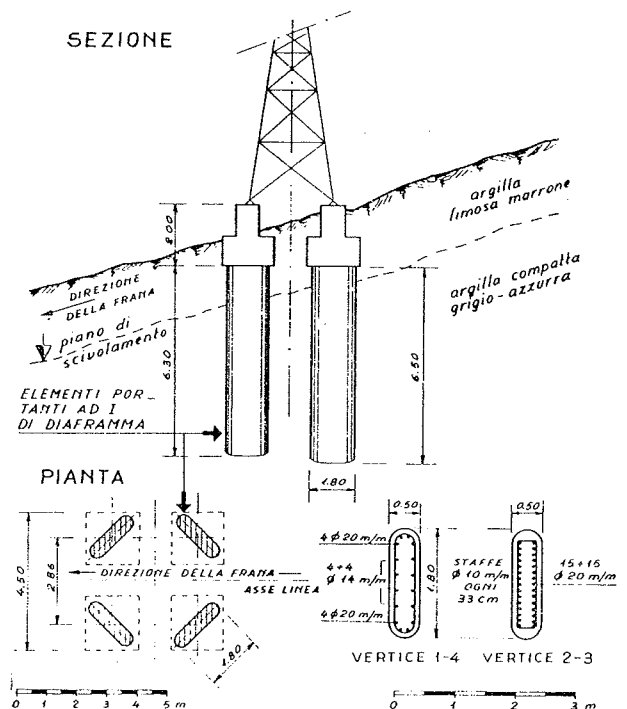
Fondazione del sostegno n. 96 su elementi portanti ad I di diaframma.
